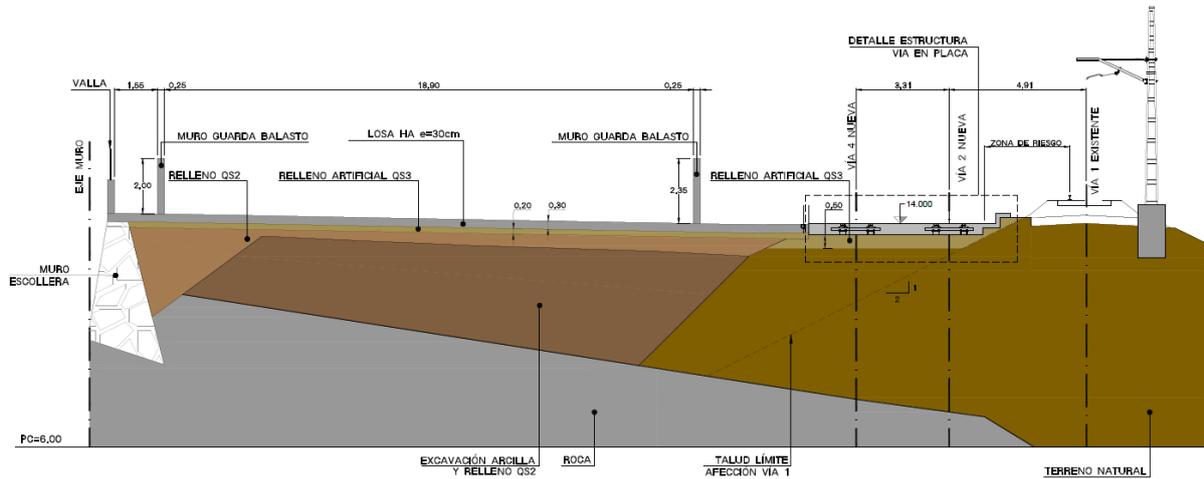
Sección general de replazo de terreno bajo losa general y vía en placa. Puede verse el talud estable de las vías siempre fuera de la influencia de las excavaciones.
